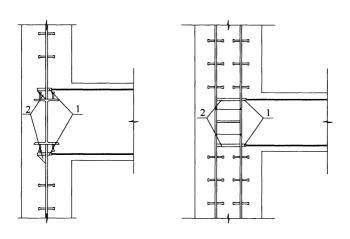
梁钢筋与钢板墙的钢筋套筒连接方式 1—钢筋连接套筒;2—加劲肋
